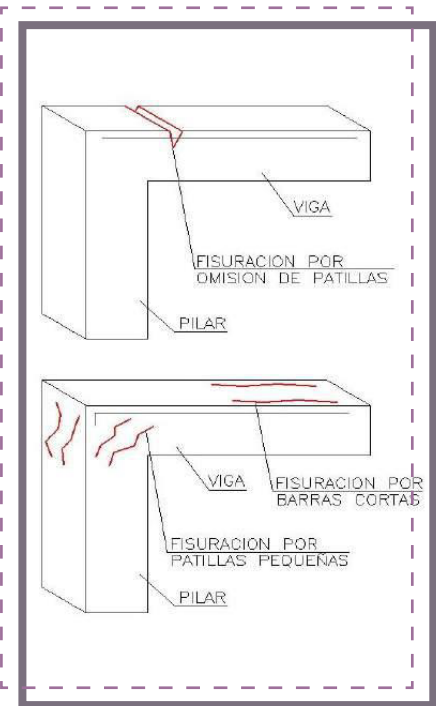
Esquema de las fisuras en viga de hormigón armado por escasa longitud de anclaje en negativos.
